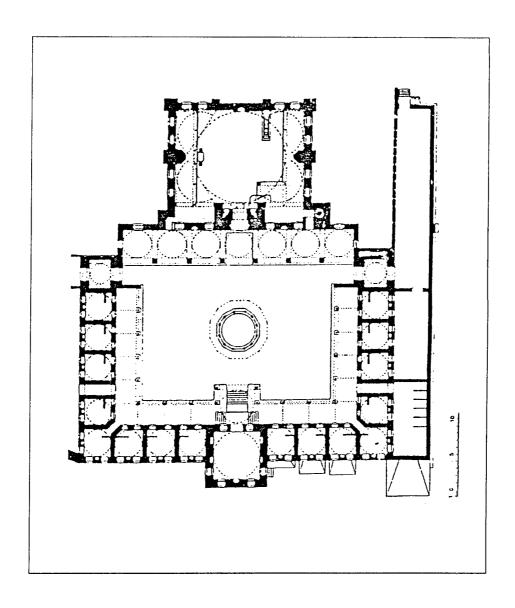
مسقط أفقي لمدرسة رستم باشا في استانبول (عن : كوران) .
